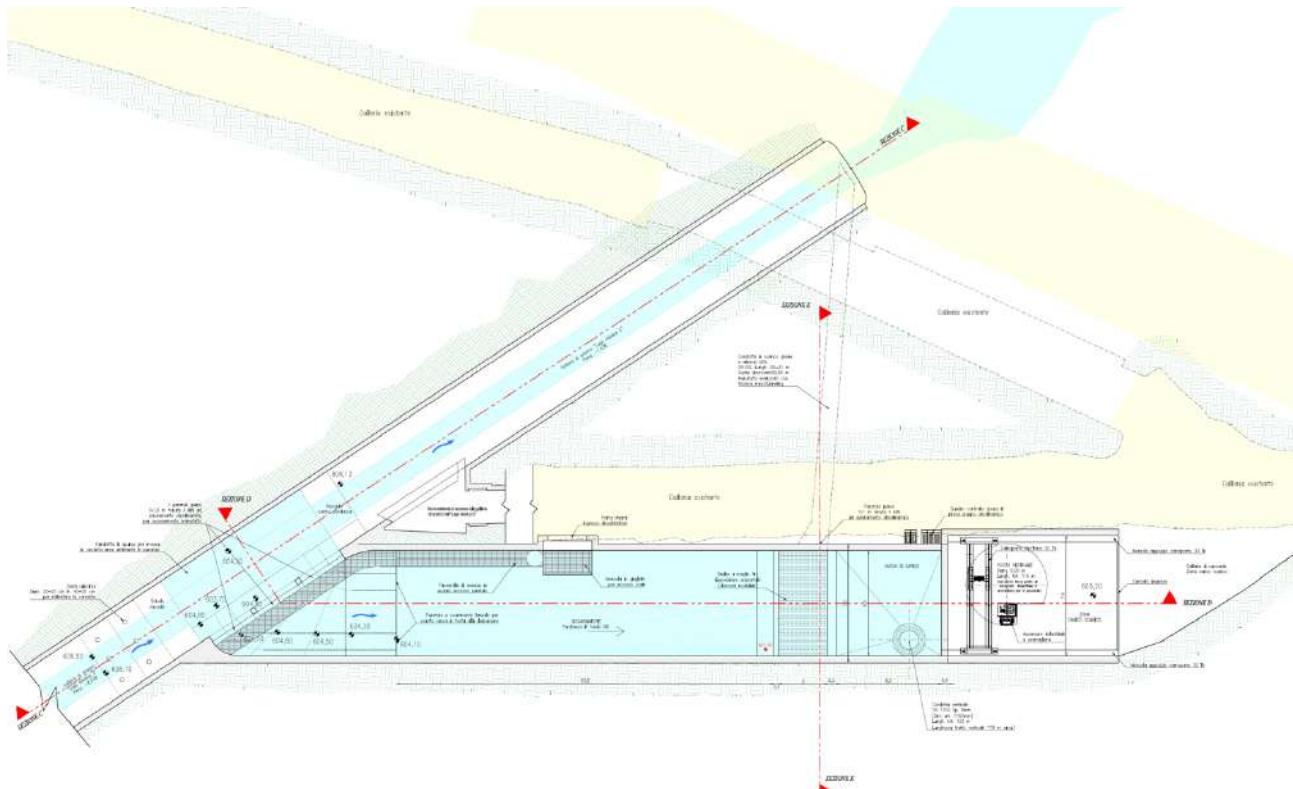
Planimetria di progetto dell'opera di presa che si innesta nella galleria di by pass e utilizza le gallerie esistenti di accesso (in giallo)
